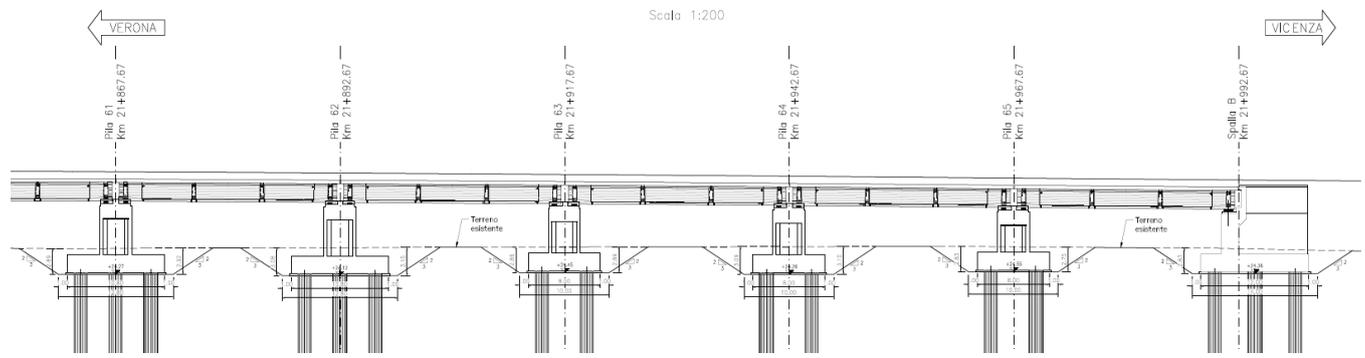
Sezione longitudinale da pila P61 a spalla B
